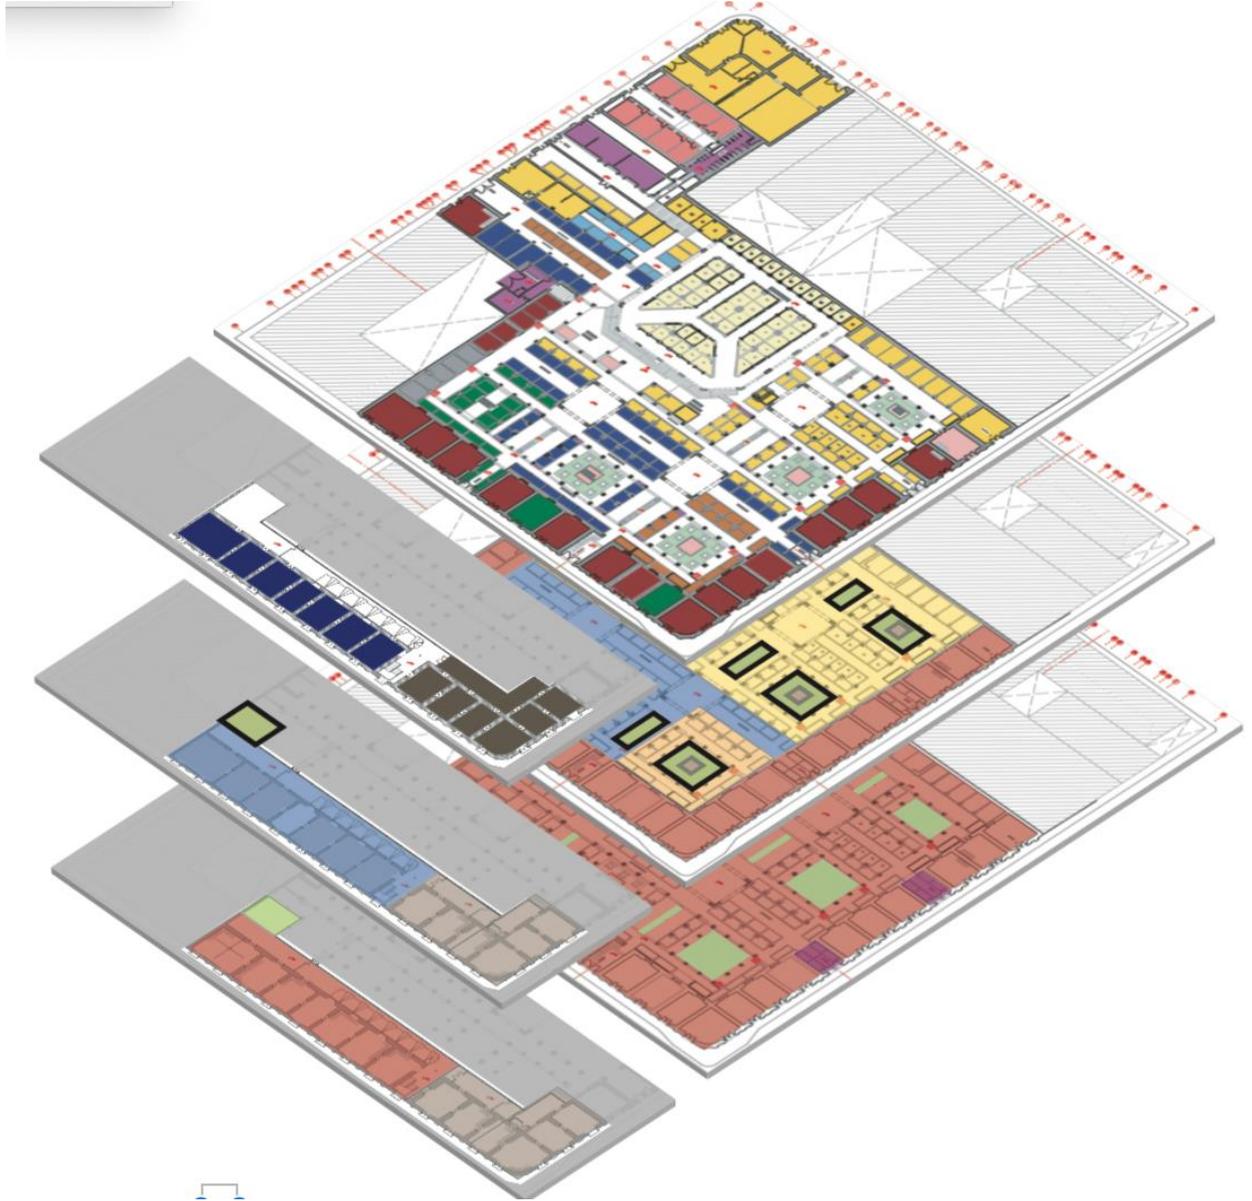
Foto de ruta de servicios propuesta, Elaboración Jeison Duque, 2019
